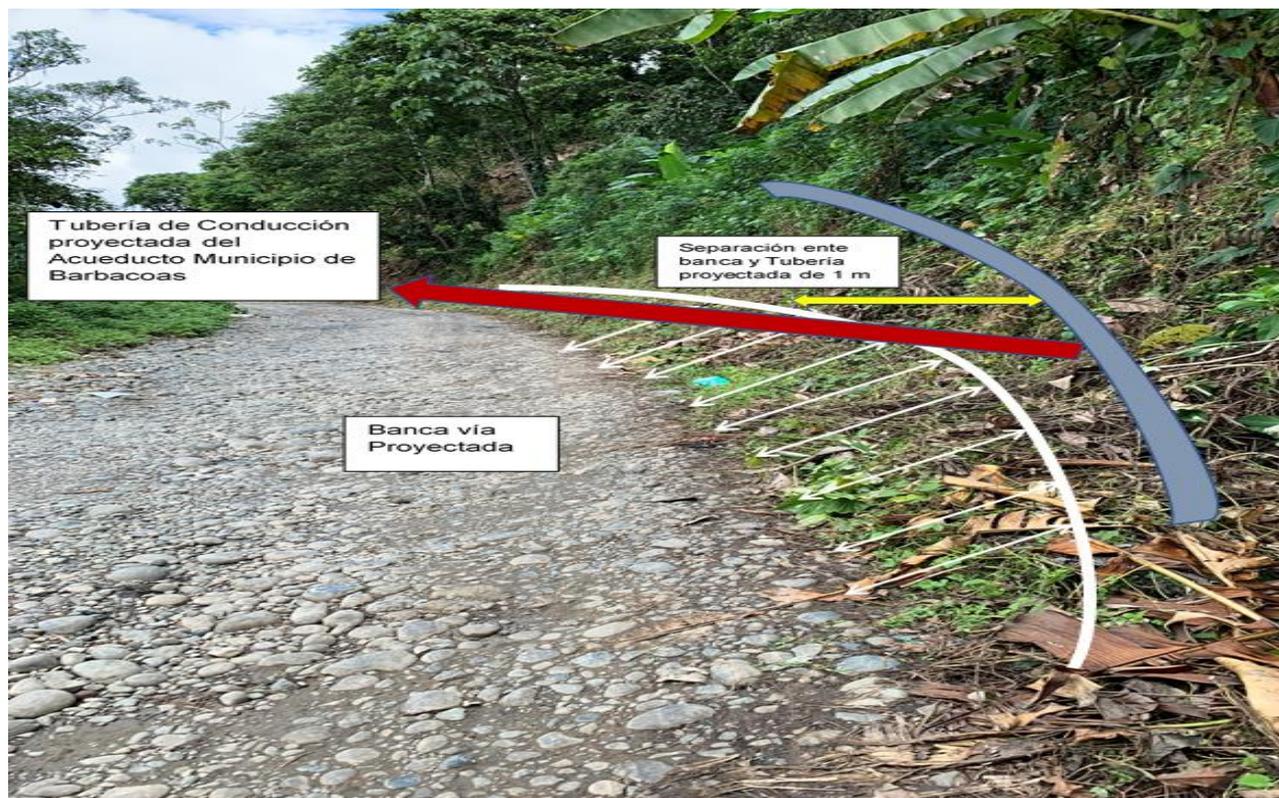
Segmento de terreno donde se instalará Tubería de Conducción de acueducto y su separación con la vía de acceso al municipio la cual está en construcción, Proyecto denominado
